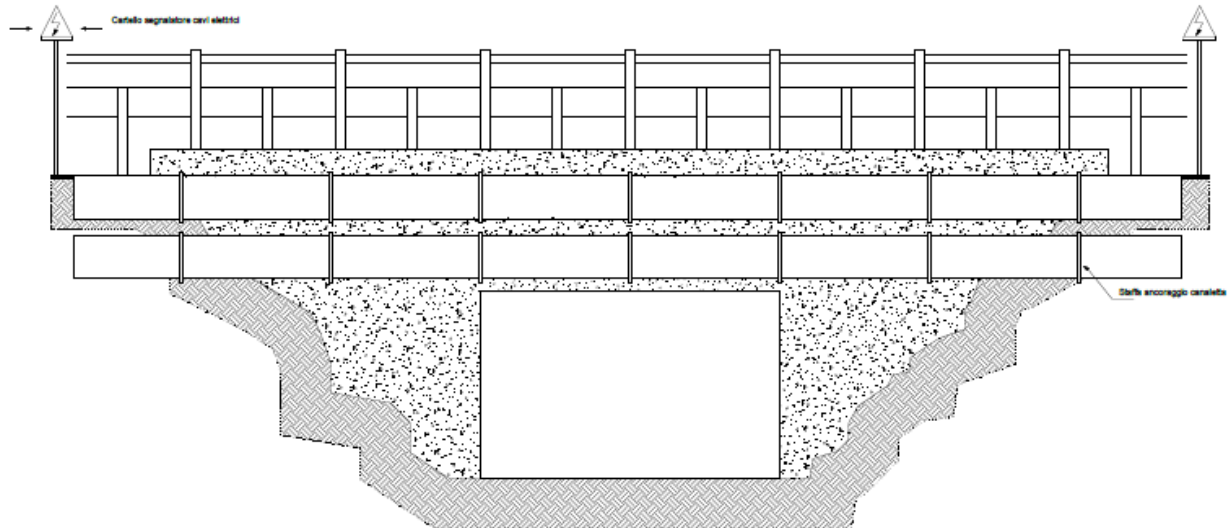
Sezione longitudinale cavidotto AT in fiancheggiamento al ponte o cavalcavia.
